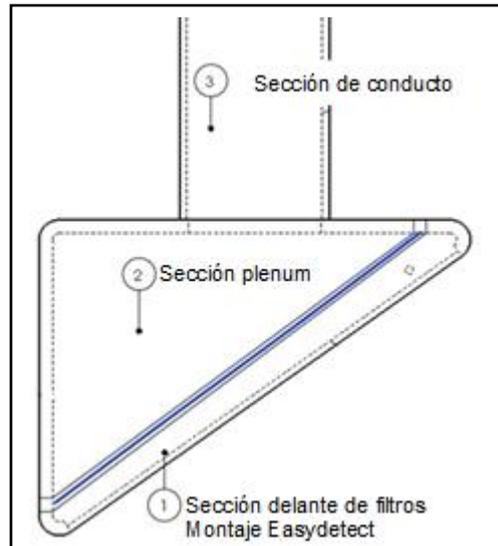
Instalación del tubo Easydetect - Vista de perfil
